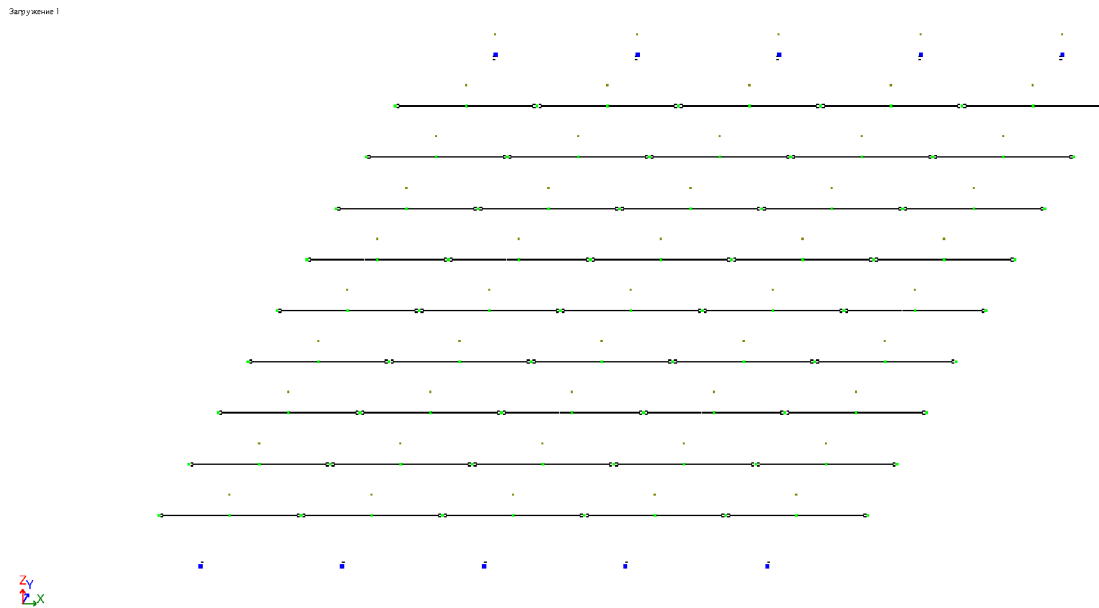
До розрахунку збірного перекриття із багатопустотних плит.
